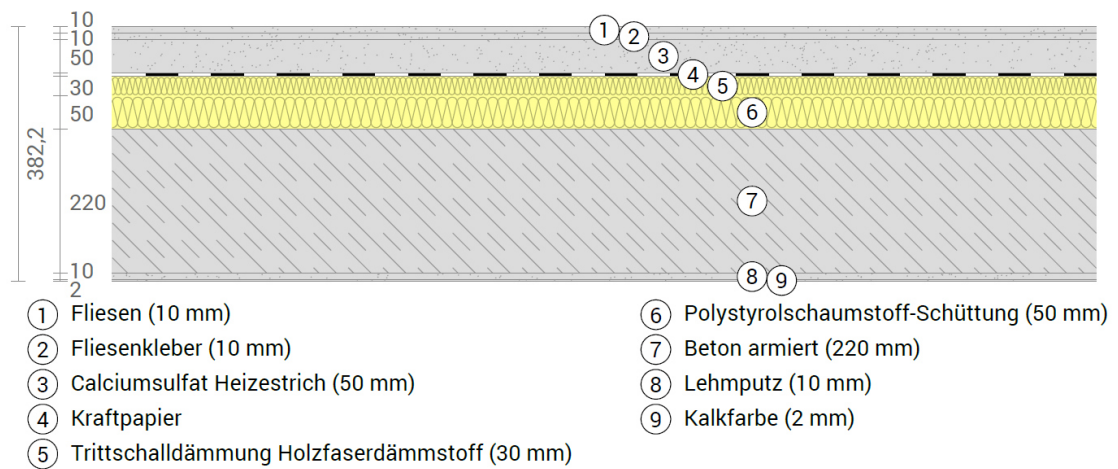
Bauteilaufbau der Geschossdecke im Verkehrsbereich (KFK-Variante)
